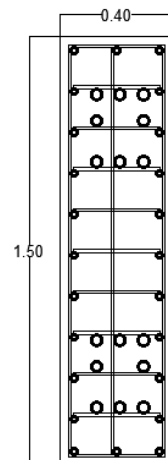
Detalle Acero Longitudinal, Transversal y Diagonal Viga de Acople B
